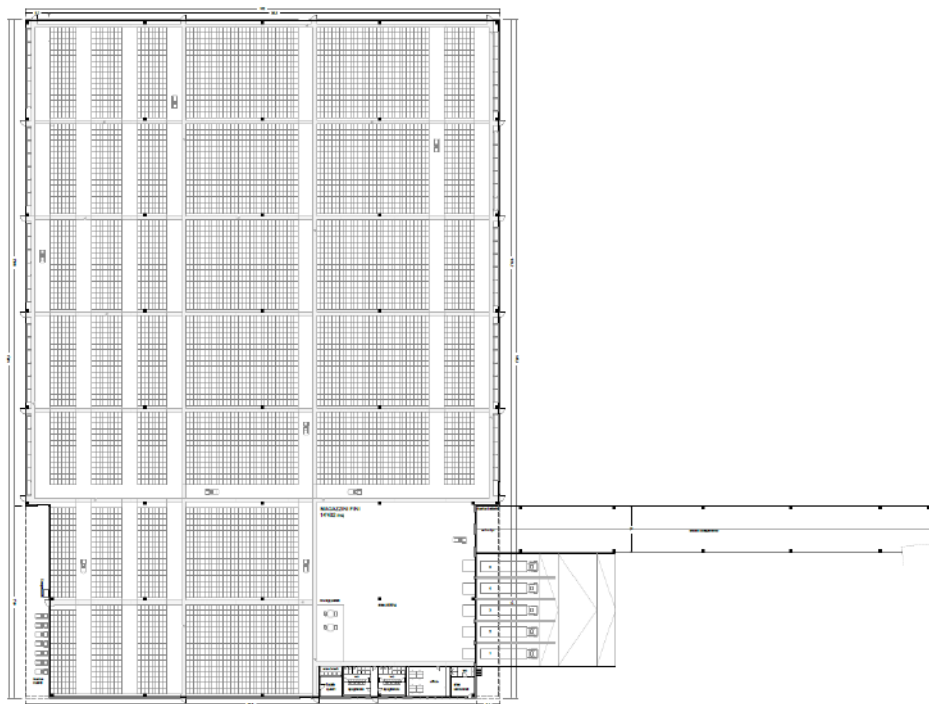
Planimetria del progetto del nuovo magazzino per stoccaggio massivo.
